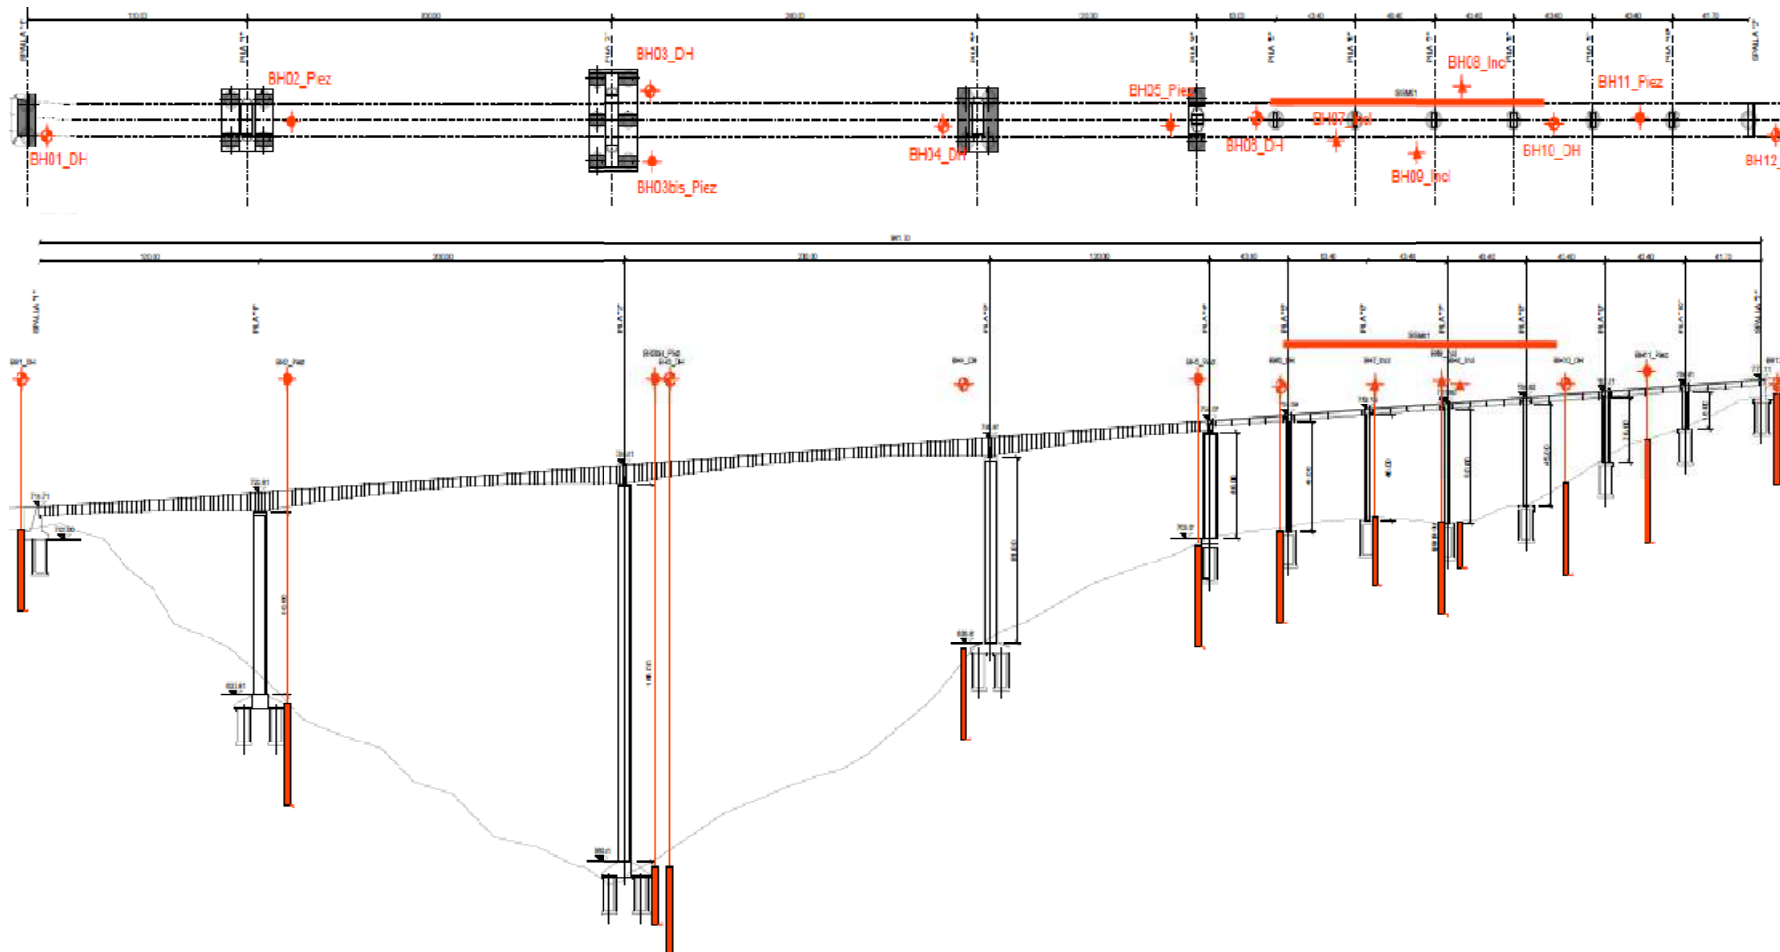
pianta delle fondazioni vista dall'alto con relativo piano d'indagine
